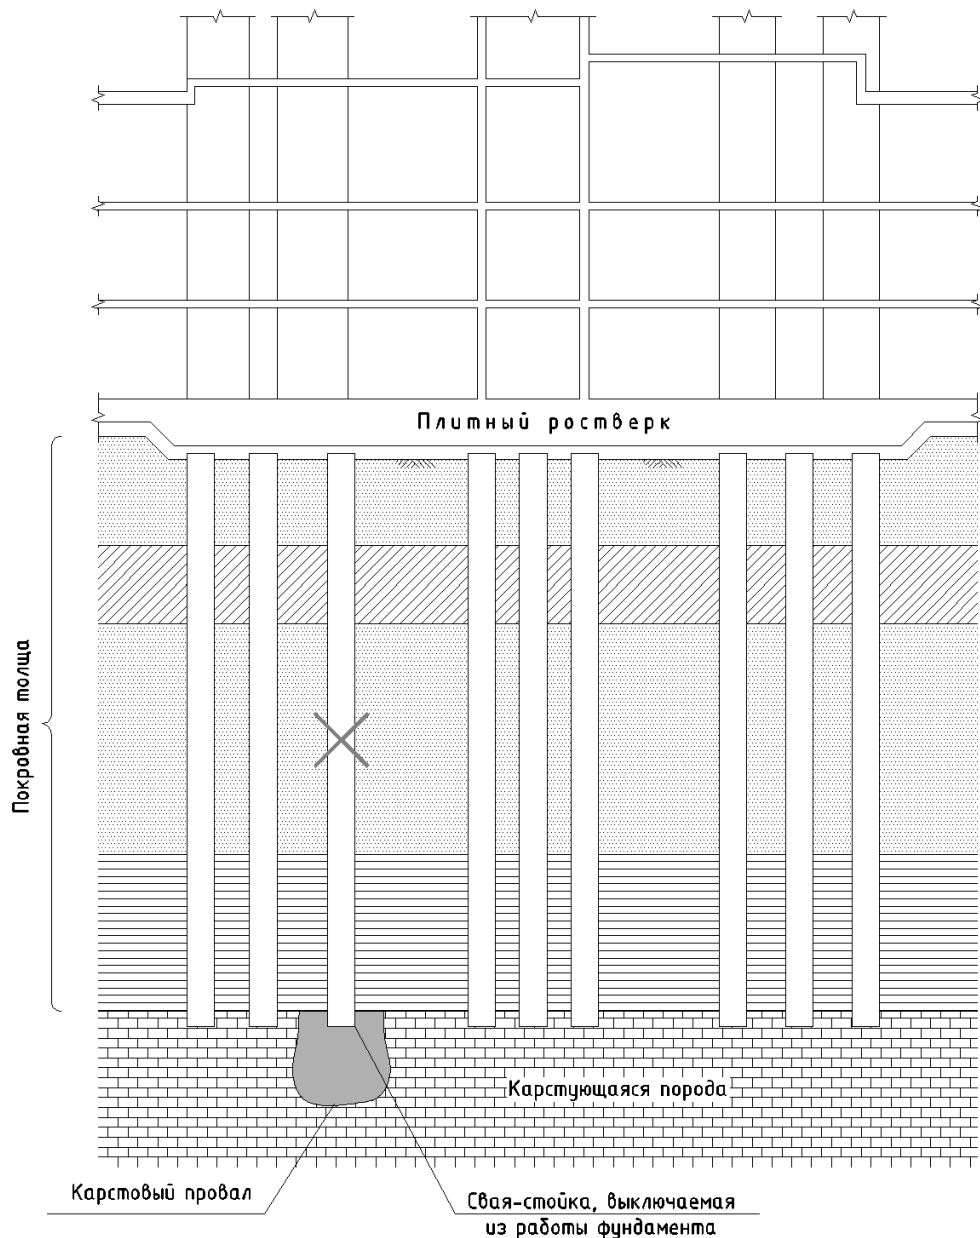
К расчету фундамента на сваях-стойках
